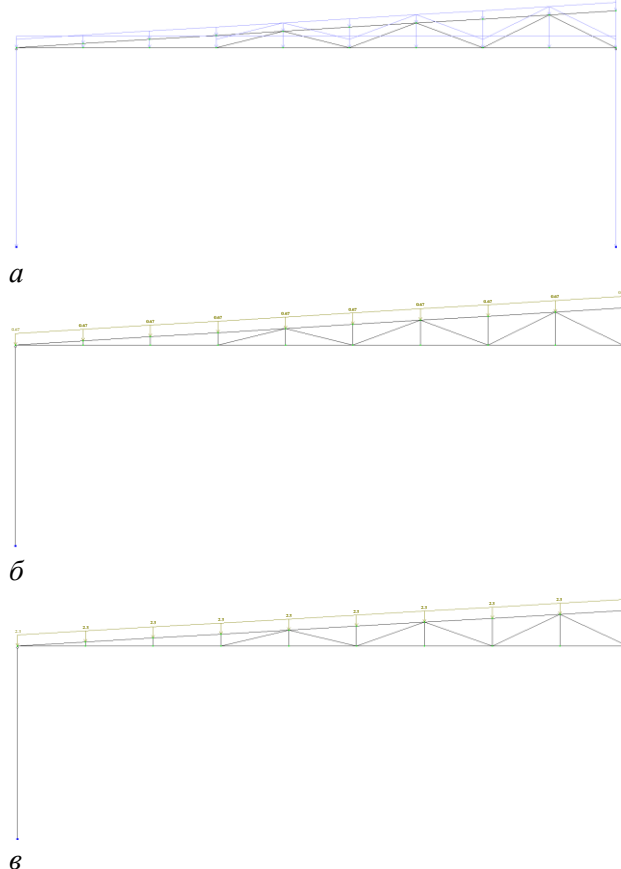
Нагрузки на расчетную схему: а – от собственного веса металлических конструкций; б – от собственного веса конструкций покрытия; в – от веса снегового покрова
